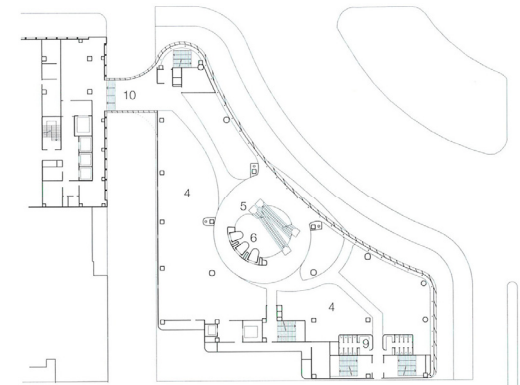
Einkaufszentrum Star Place, Grundriss, Arch. UNStudio
